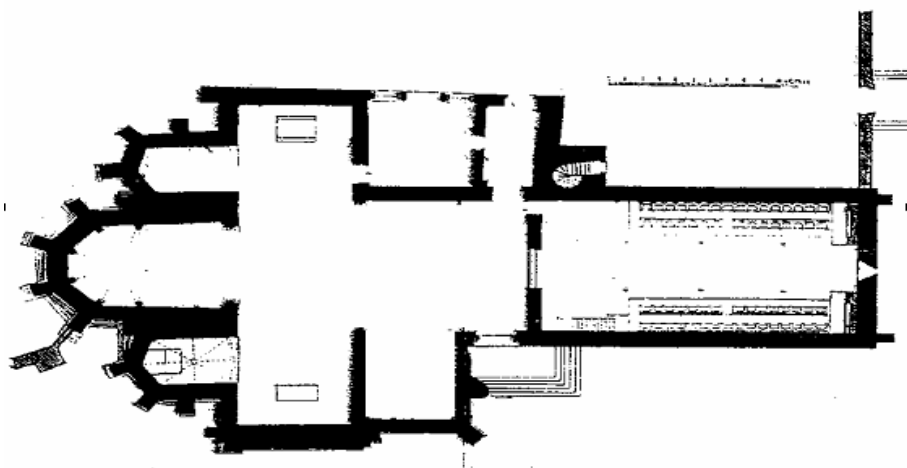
Planta da igreja de Santa Clara (Vila do Conde) [3]
